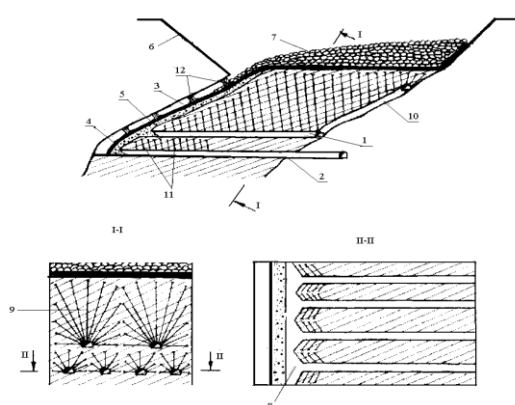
Способ комбинированной разработки мощных рудных тел: 1-буровая выработка, 2-доставочная выработка, 3-отрезная щель, 4-отбитая руда монтажного слоя, 5-гибкое разделяющее перекрытие, 6-карьер, 7-отвал пустых пород, 8-подсечка, 9-скважины, 10-наклонная выработка, 11-скважины, 12-временные целики.
